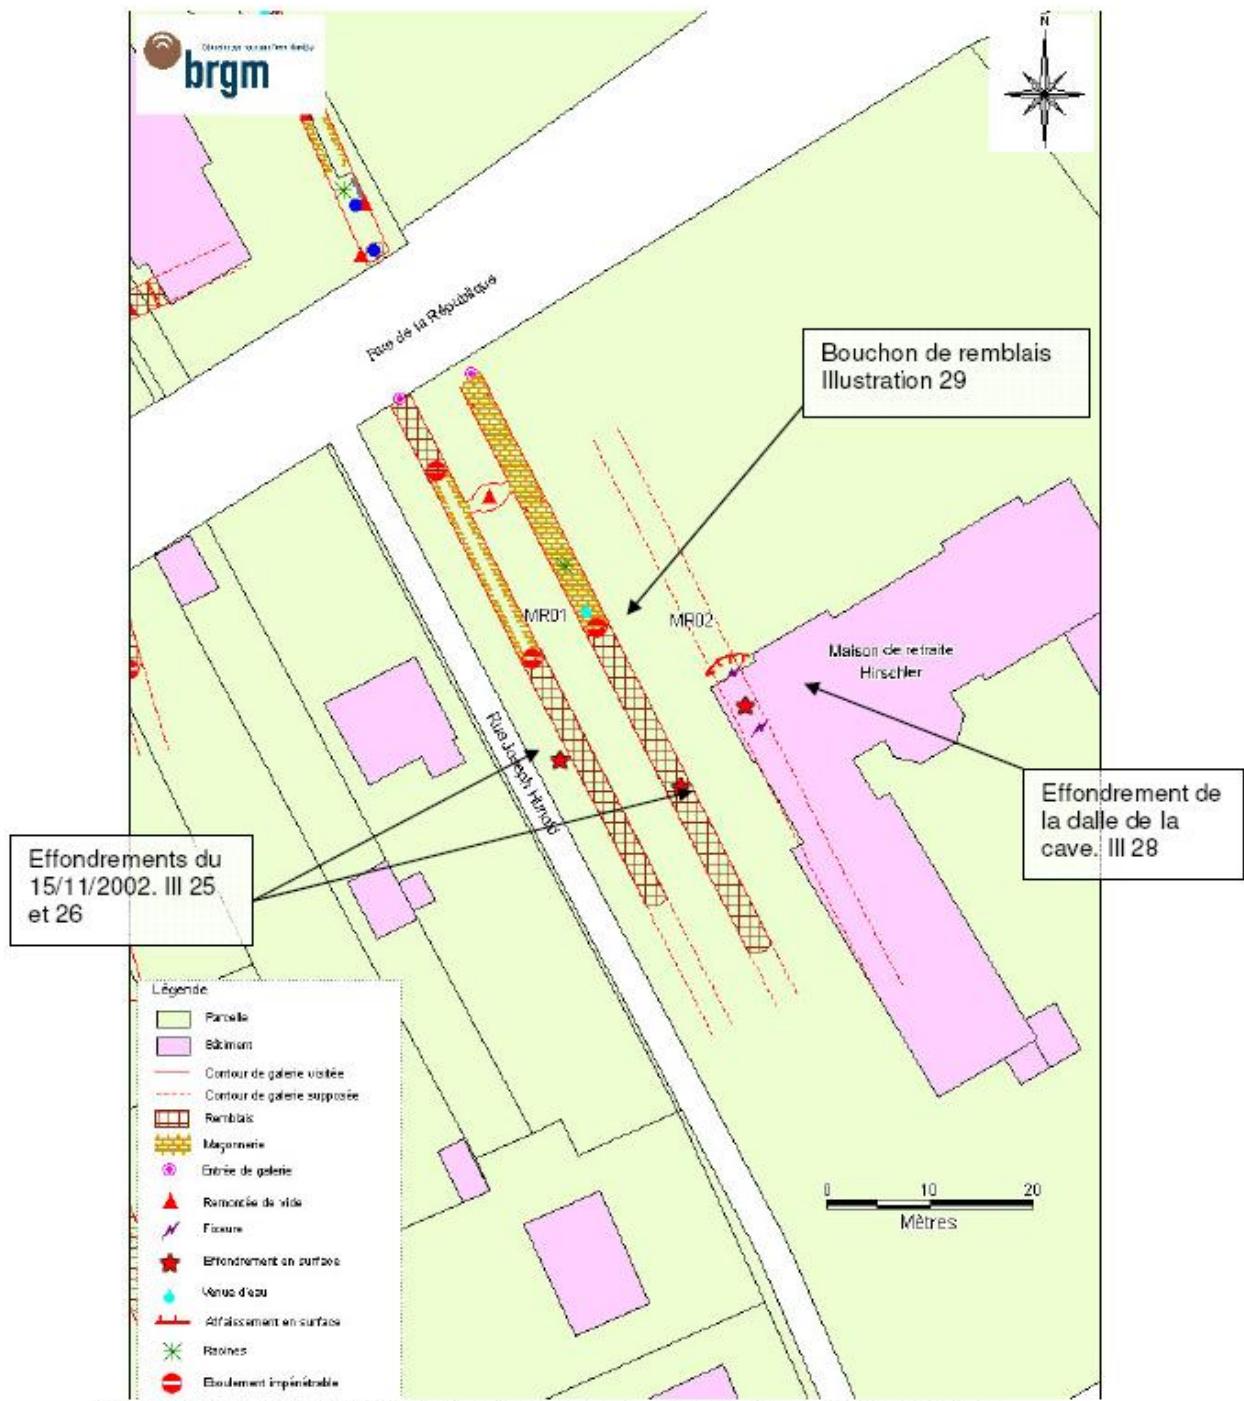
Plan des galeries situées sous la maison de retraite René Hirschler.
